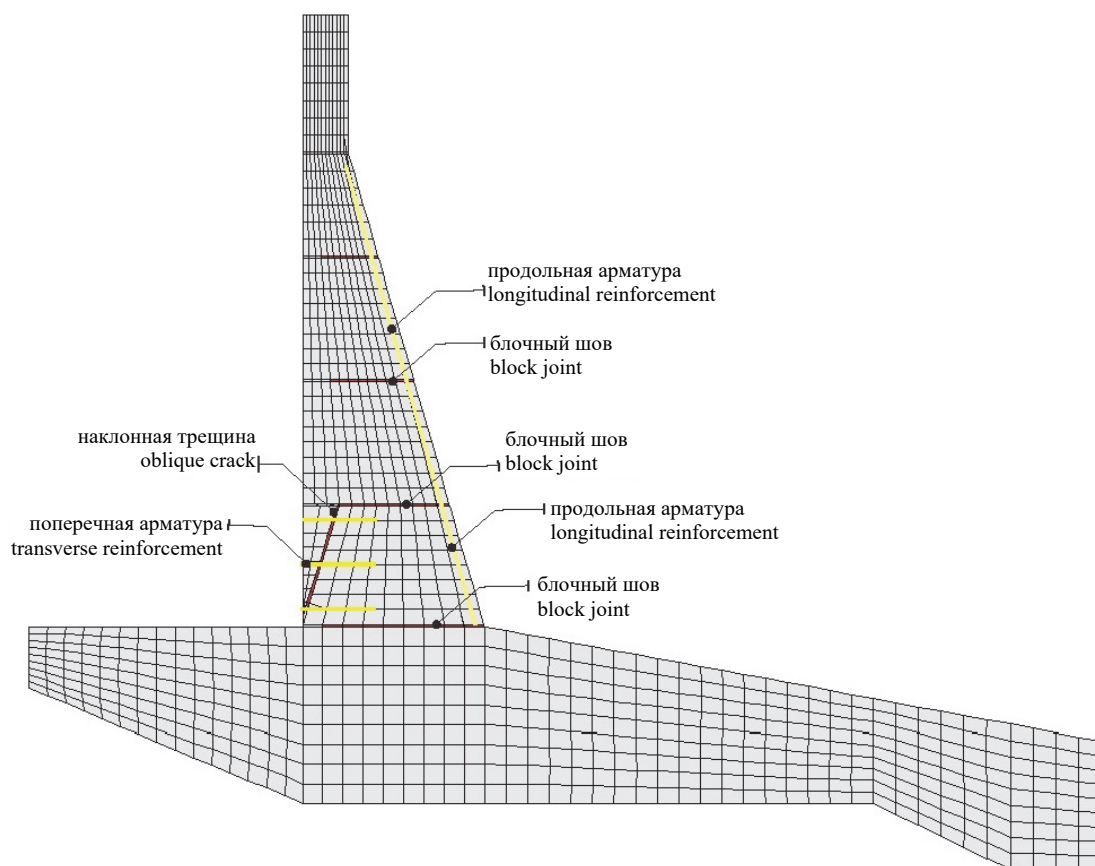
Моделирование горизонтальной поперечной арматуры, пересекающей наклонную вторичную трещину
